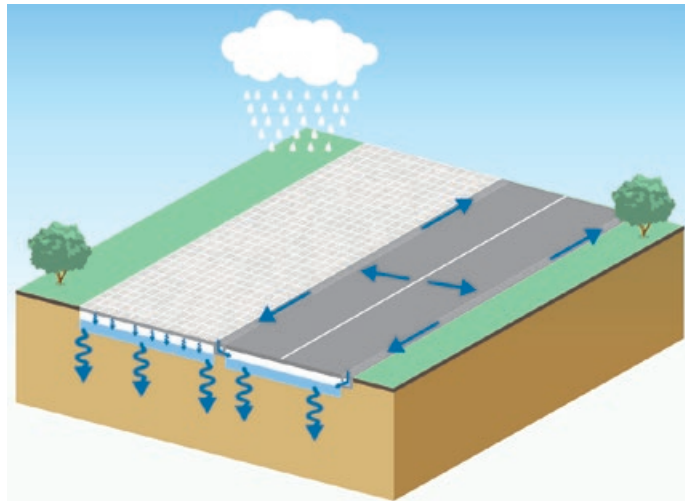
Chaussée à structure réservoir revêtue de pavés poreux (gauche) ou de béton traditionnel (droite).
